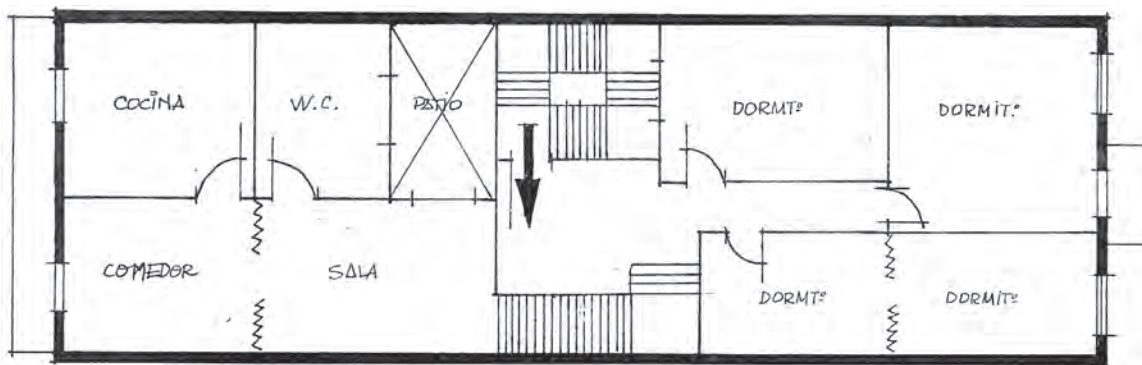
17. 1984. PLANO DE LA 3ª PLANTA ANTES DE LA REFORMA
